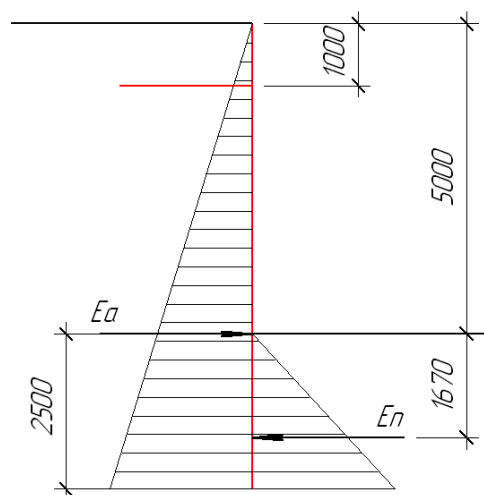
Крепление стенок котлована шпунтовым свайным рядом с анкером:
